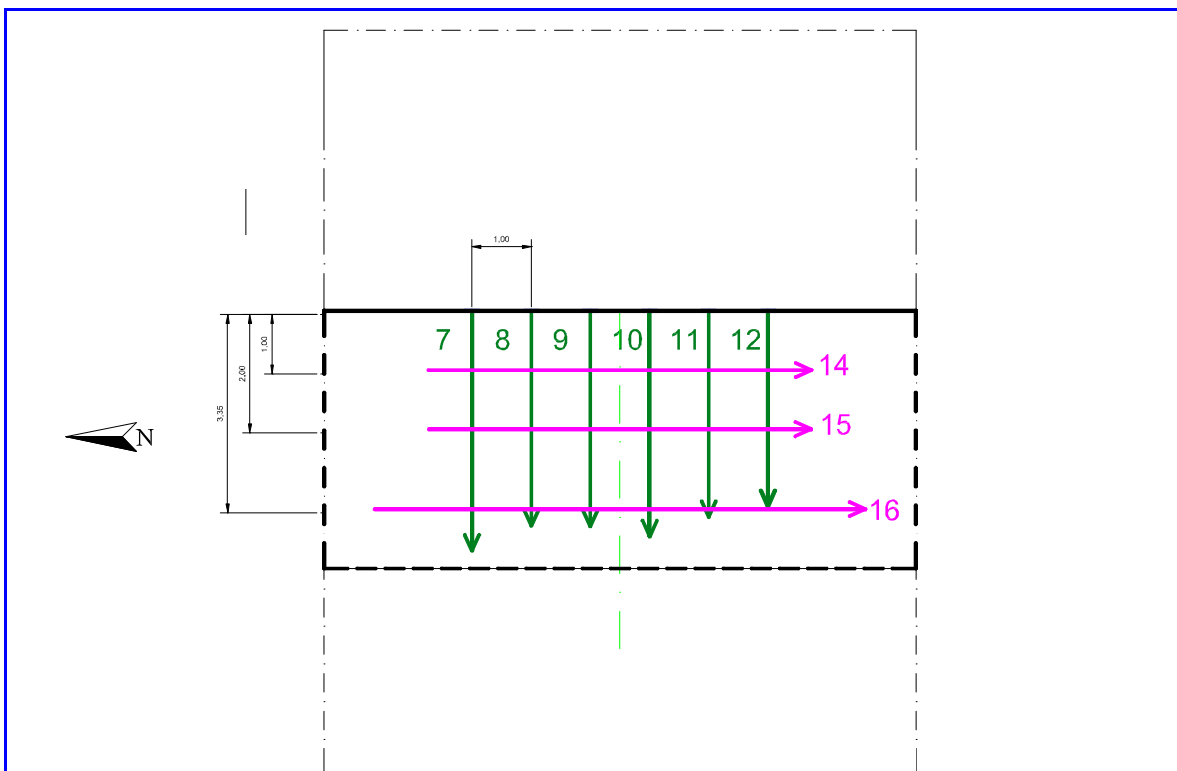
SP 14 - km 10+110 - Prospetto dell'area di prova
